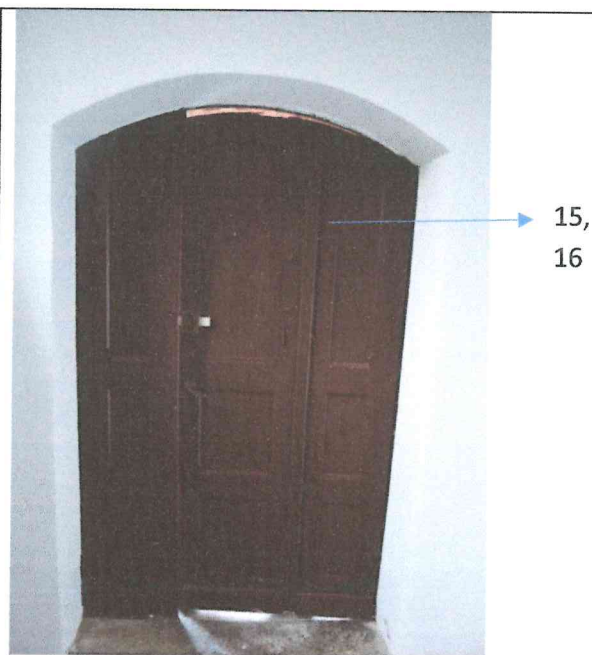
Kętrzyn, stolarka drzwiowa- elewacja frontowa, miejsce pobrania próbek z drzwi głównych. Fot. B. Kwasiborska, 2022 r.
